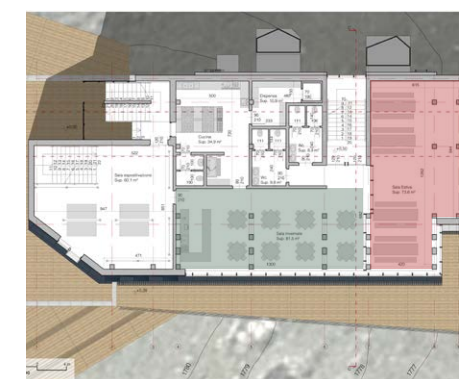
Planimetria del piano terra e distinzione tra sala invernale (verde) ed estiva (rossa)
